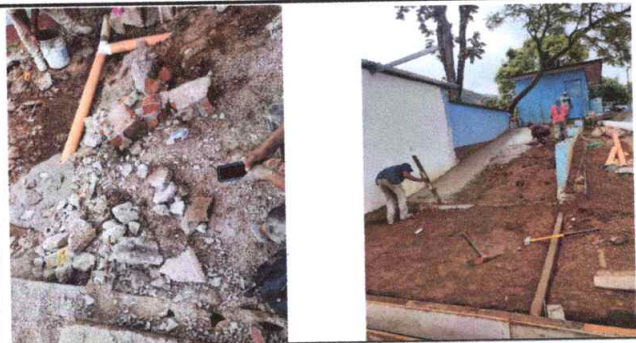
en proceso fundición de la rampa y reparación de drenajes
